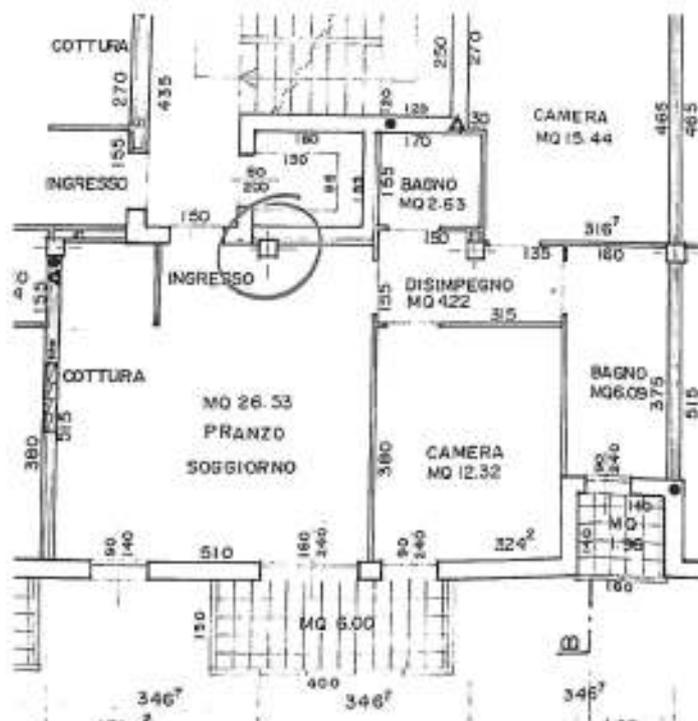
Pianta piani 1 + 2 + 3 - estratto da elaborato grafico architettonico
